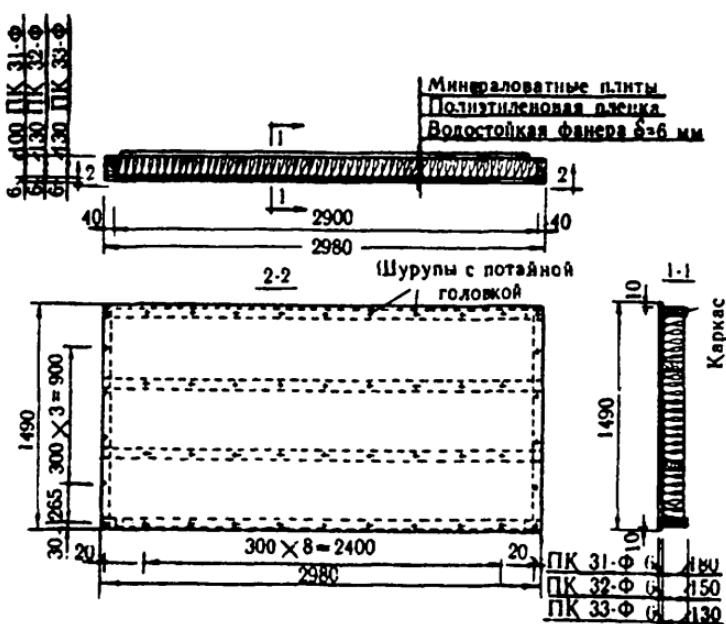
Конструкция плиты покрытия и подвесного потолка
